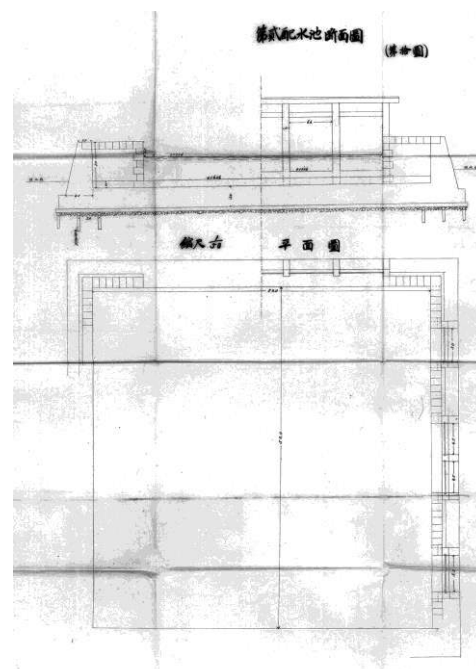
第1次（当初案）における第二配水池の断面図及び平面図
